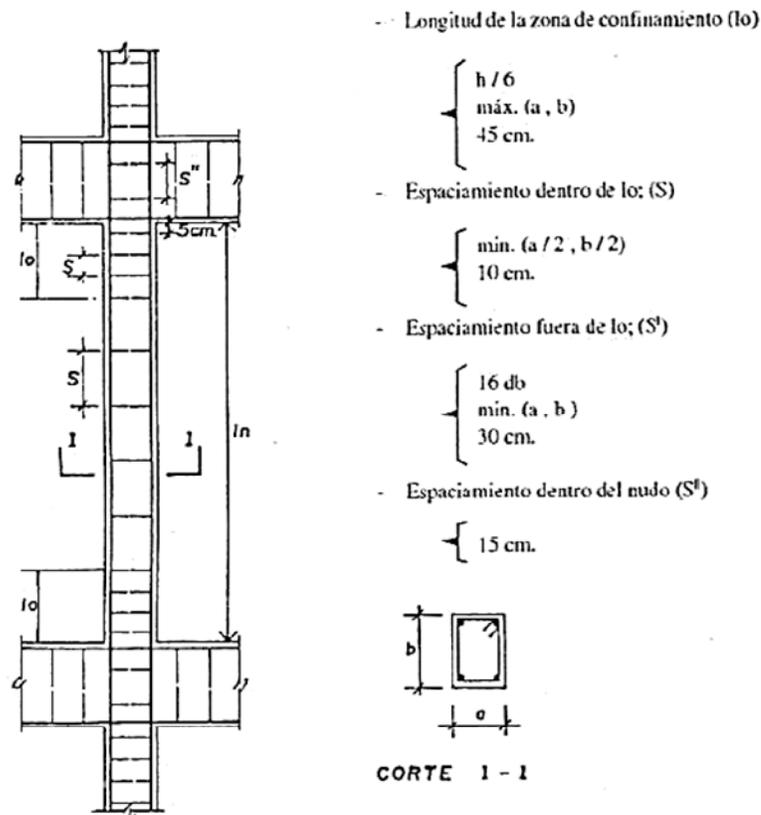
Disposiciones para el espaciamiento de estribos en columnas según la Norma E.060.
